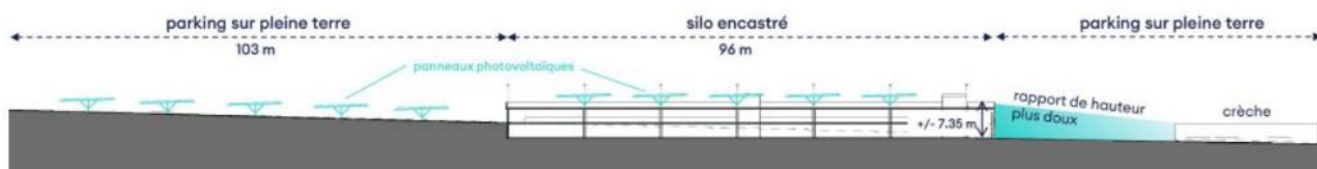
Coupe longitudinale du parking principal (source : assar architects)
